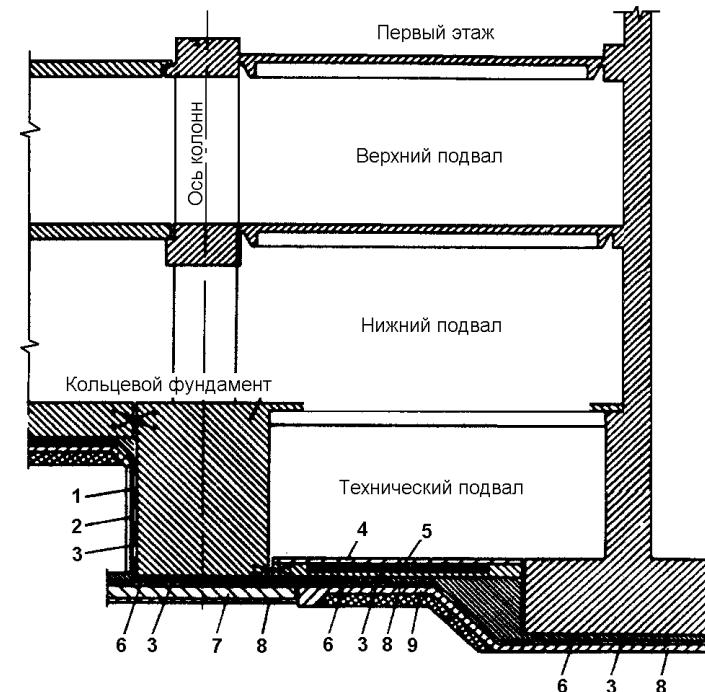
Конструкция фундаментов ядра (справа) и колонн здания.
